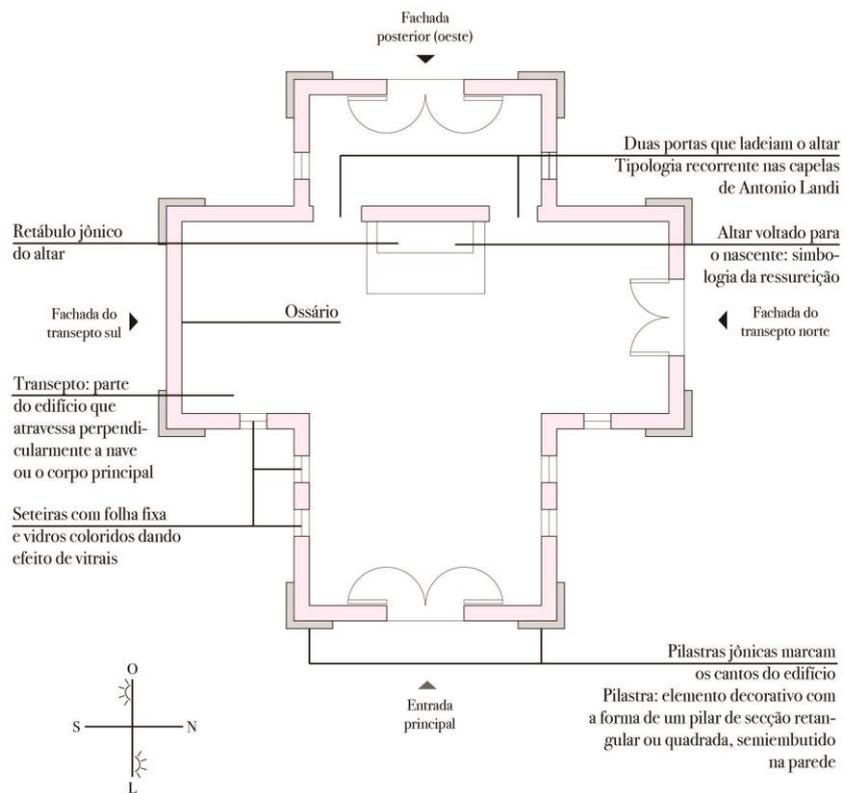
Capela de Santa Clara – Croqui da Planta baixa.
